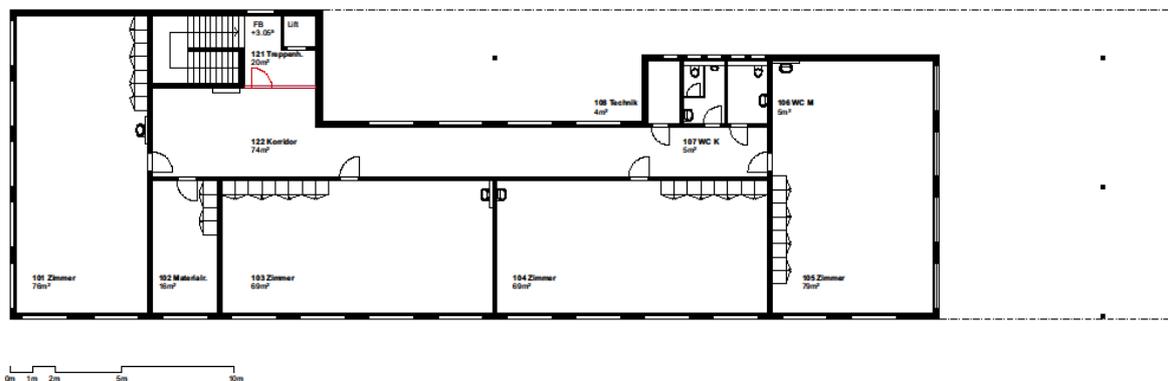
Grundriss Obergeschoss bestehendes Schulraumprovisorium
